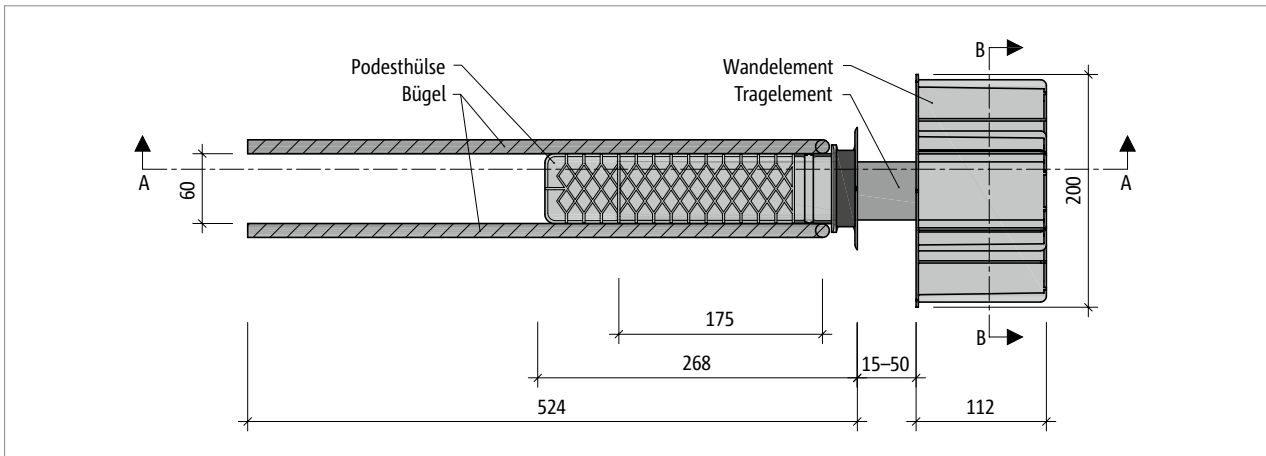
Schöck Tronsole® Typ P: Produktgrundriss
